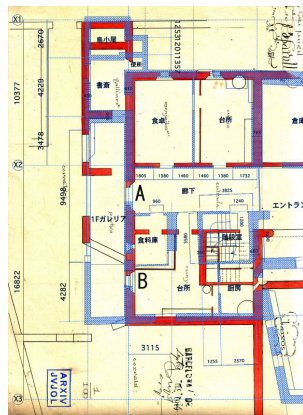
ジュジョール自身による改築前1階平面図と現状の実測1階平面図との比較
